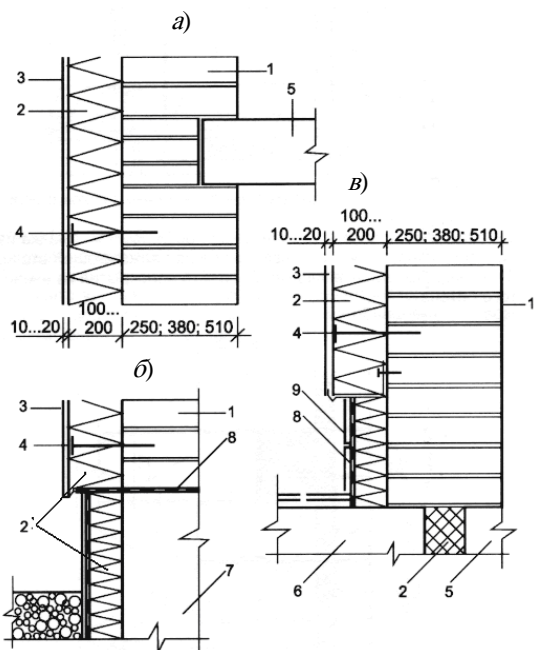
Кирпичная стена с наружной оштукатуренной теплоизоляцией:
